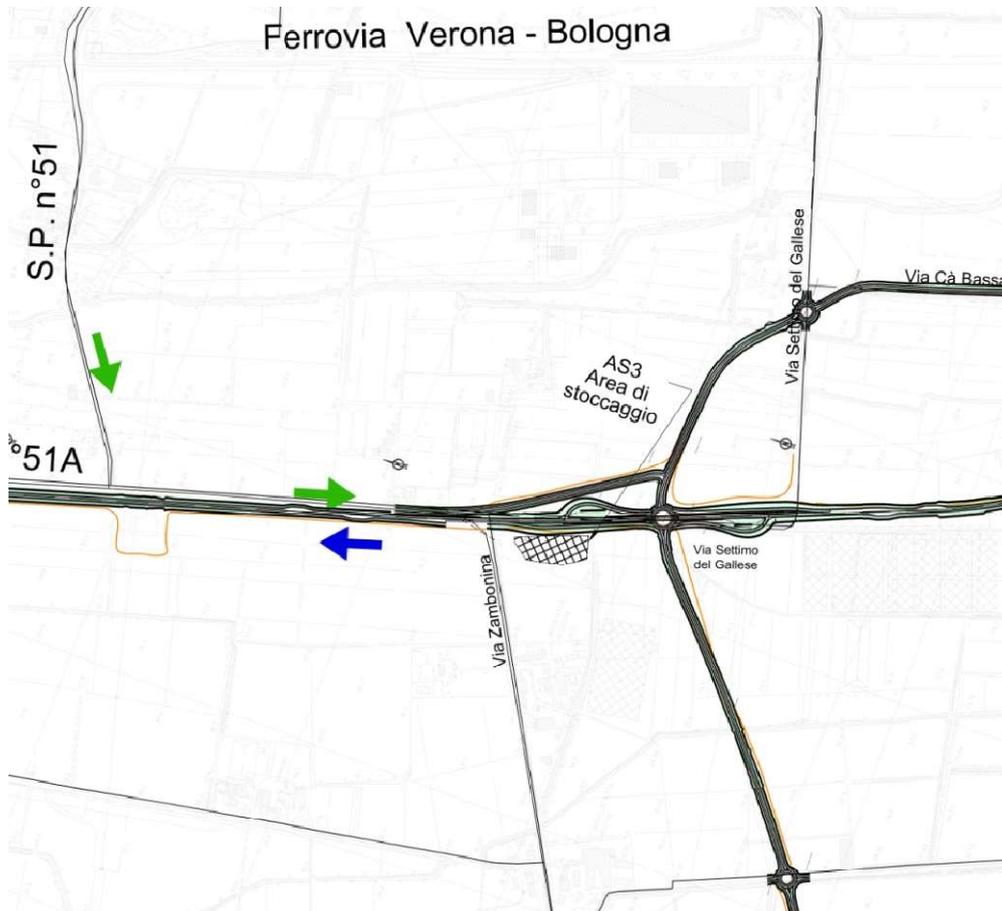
Stralcio 21-004_T00CA00CANPL02_A – Planimetria aree e viabilità di cantiere
